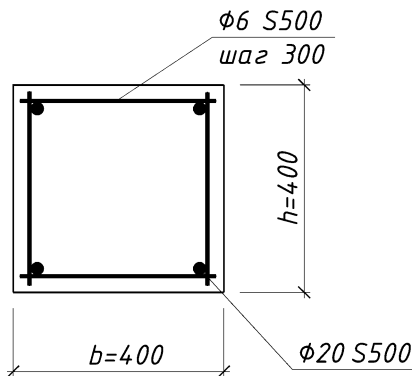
Размещение продольной арматуры в поперечном сечении колонны
